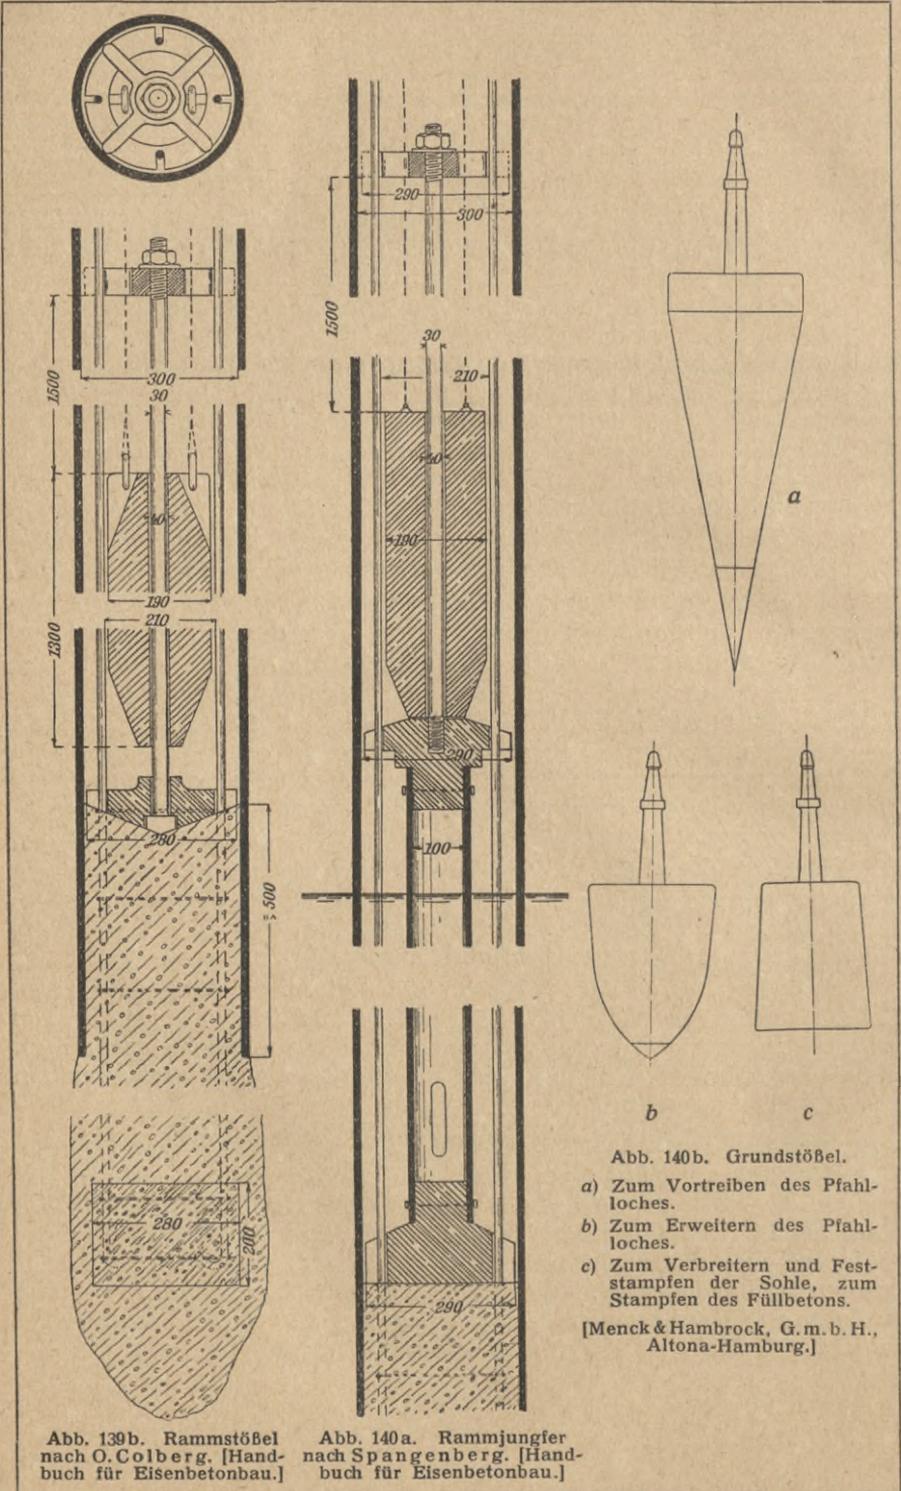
Rammstößel nach O. Colberg. [Handbuch für Eisenbetonbau.]
